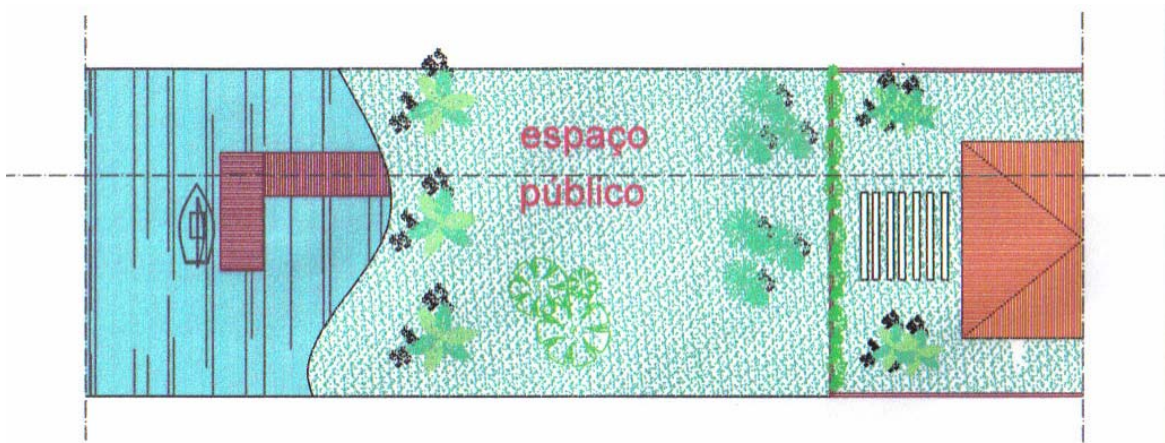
Planta baixa Orla do Lago Paranoá - Ocupação indevida de Área de Preservação Permanente (APP) por residência unifamiliar.
